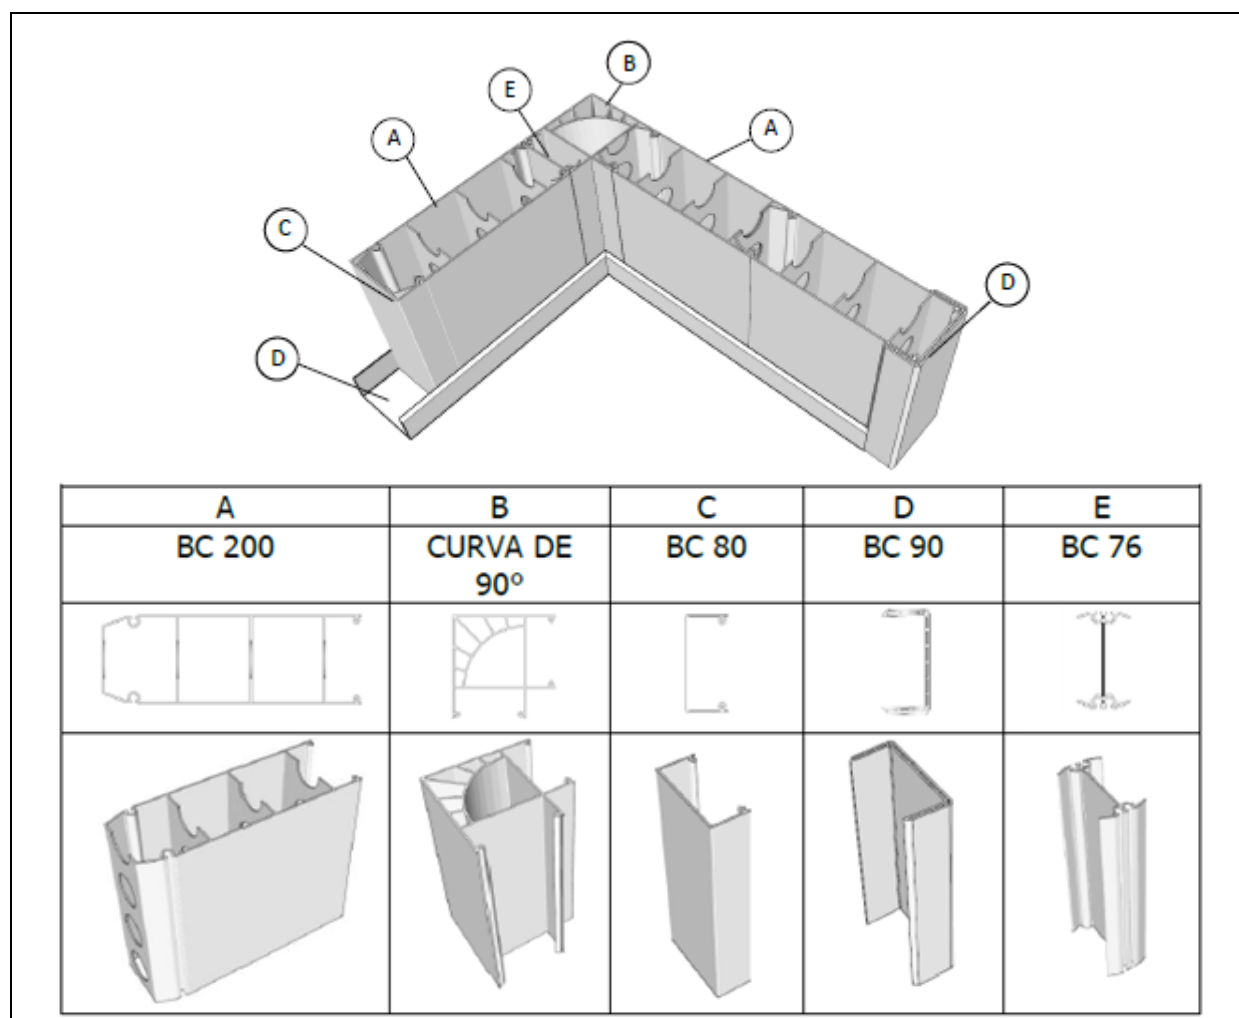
Tipos de perfis de PVC utilizados na montagem das paredes do Sistema Construtivo Bazze PVC. (Sem escala).
